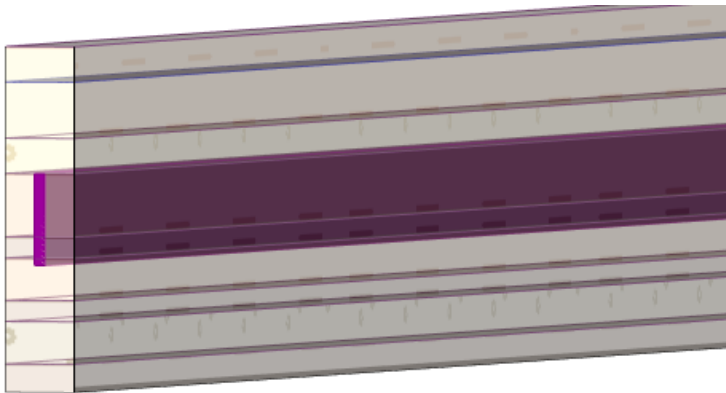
20. *Grouting* Beton Terowongan *Uptrack
